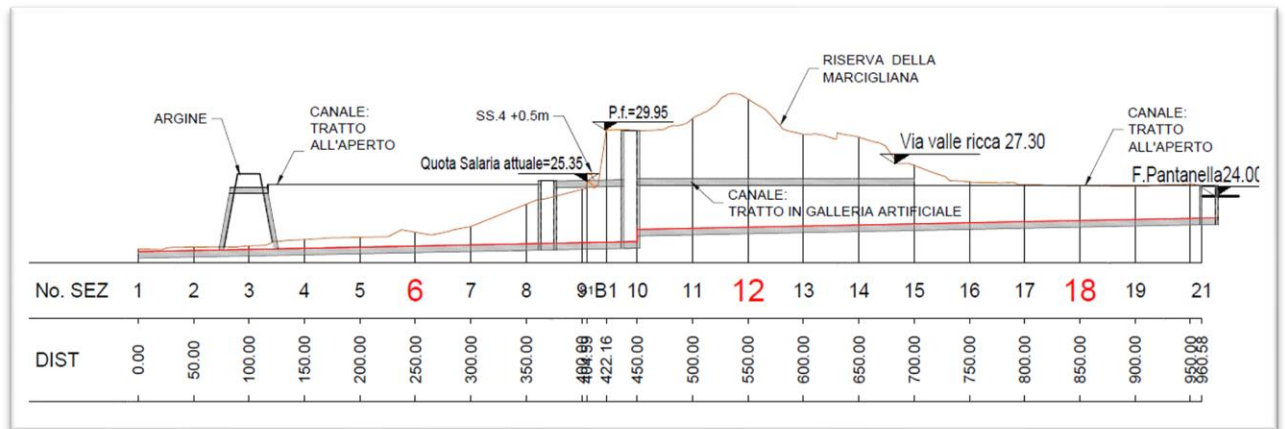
PLANIMETRIA, PROFILO E SEZIONI CANALE
